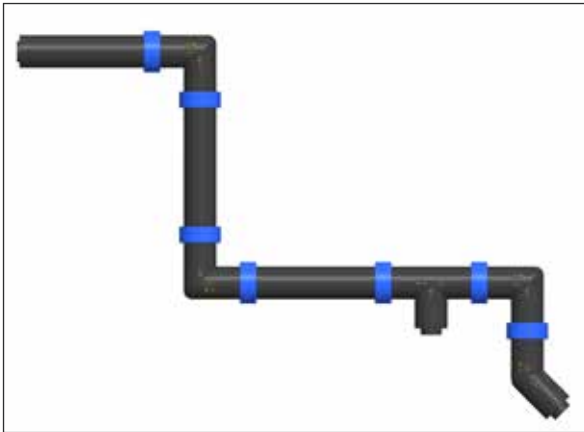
Fertig geschweißte Rohrleitung
